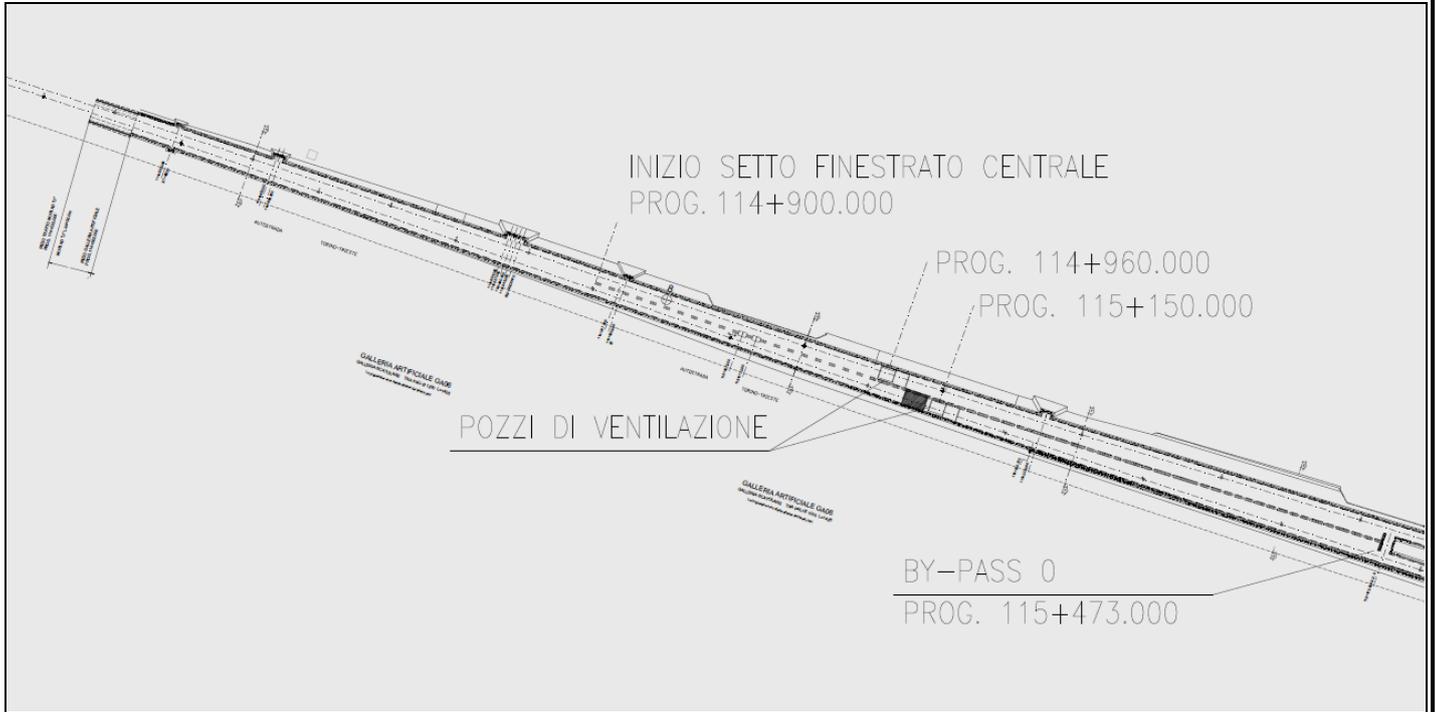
Stralcio di planimetria, zona interessata dalla disconnessione aeraulica
